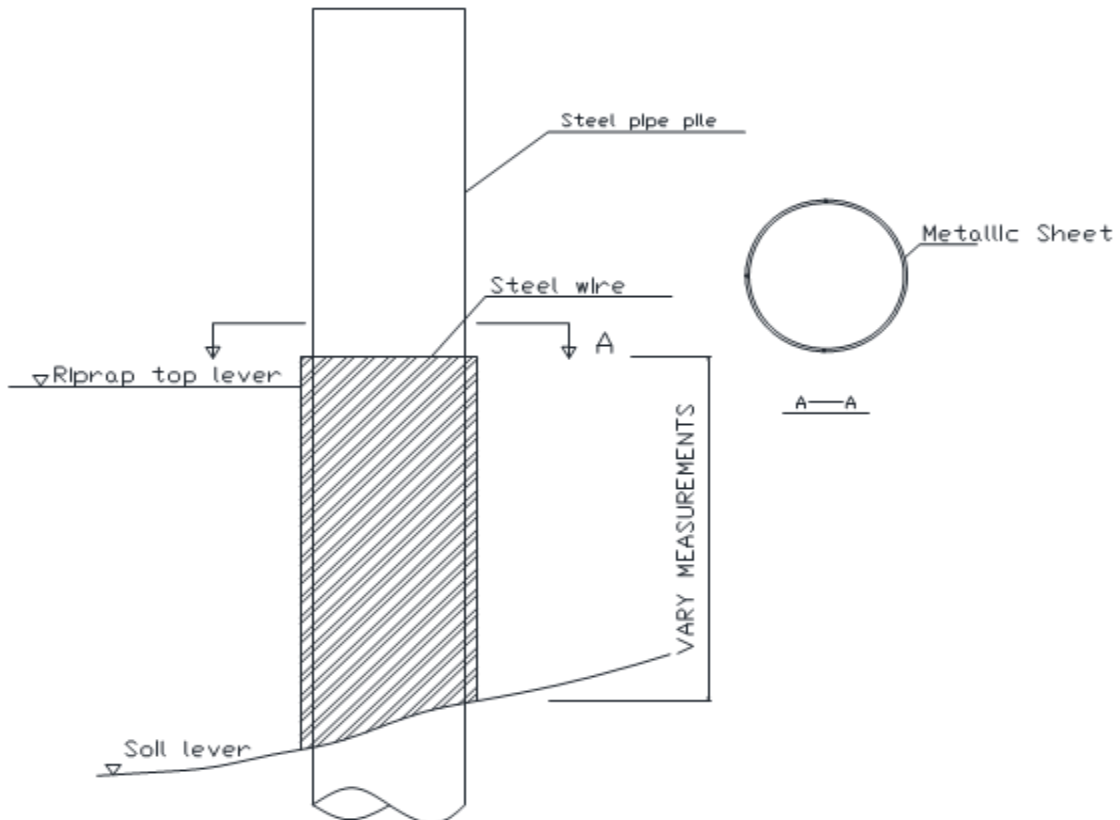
Detalle de revestimiento del recubrimiento de pilas.
